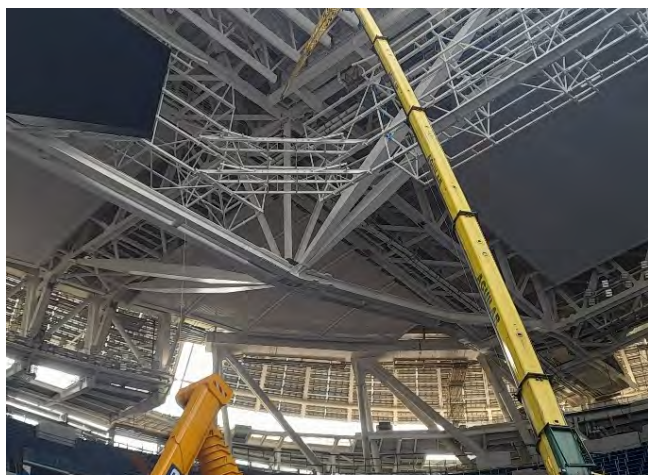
Izado y colocación del entramado de vigas de la estructura horizontal de las curvas.
